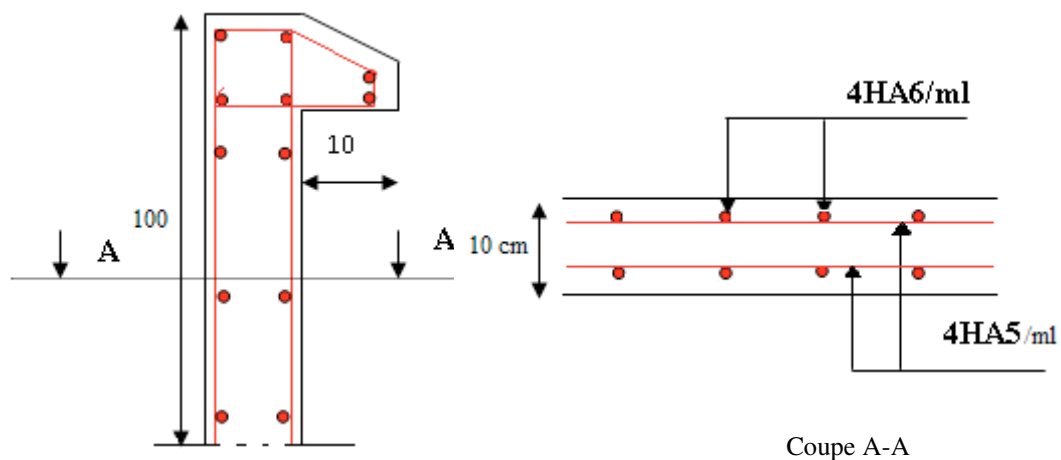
Schéma de ferrailage de l'acrotère type1 (terrasse accessible).
